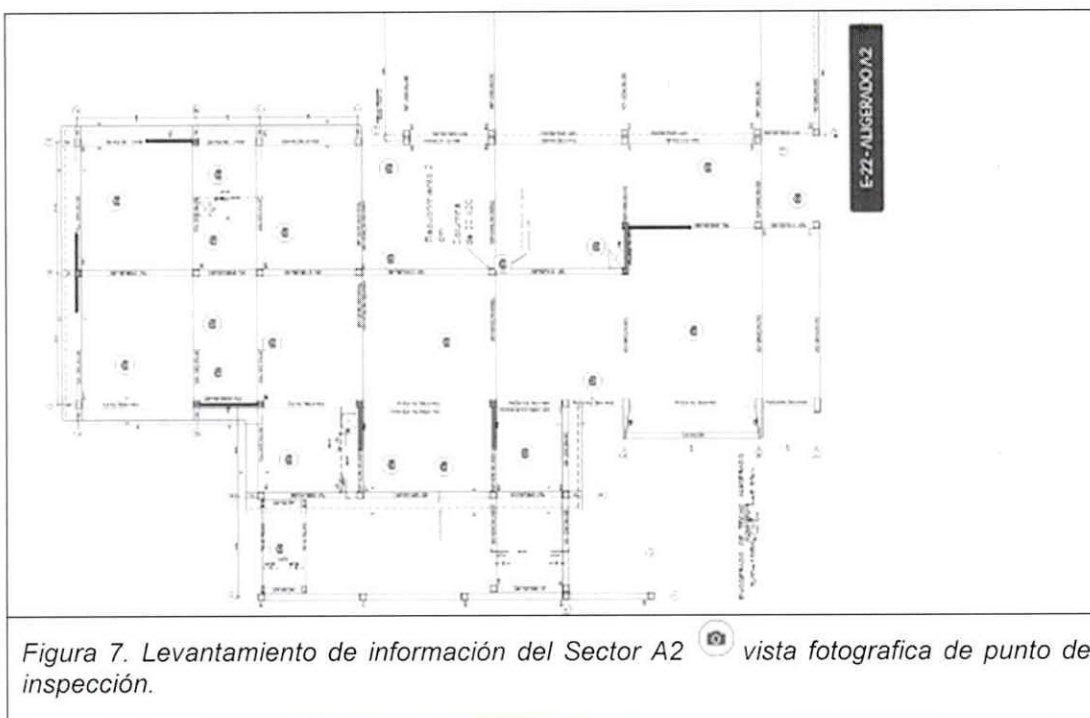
Levantamiento de información del Sector A2  vista fotografica de punto de inspección.
